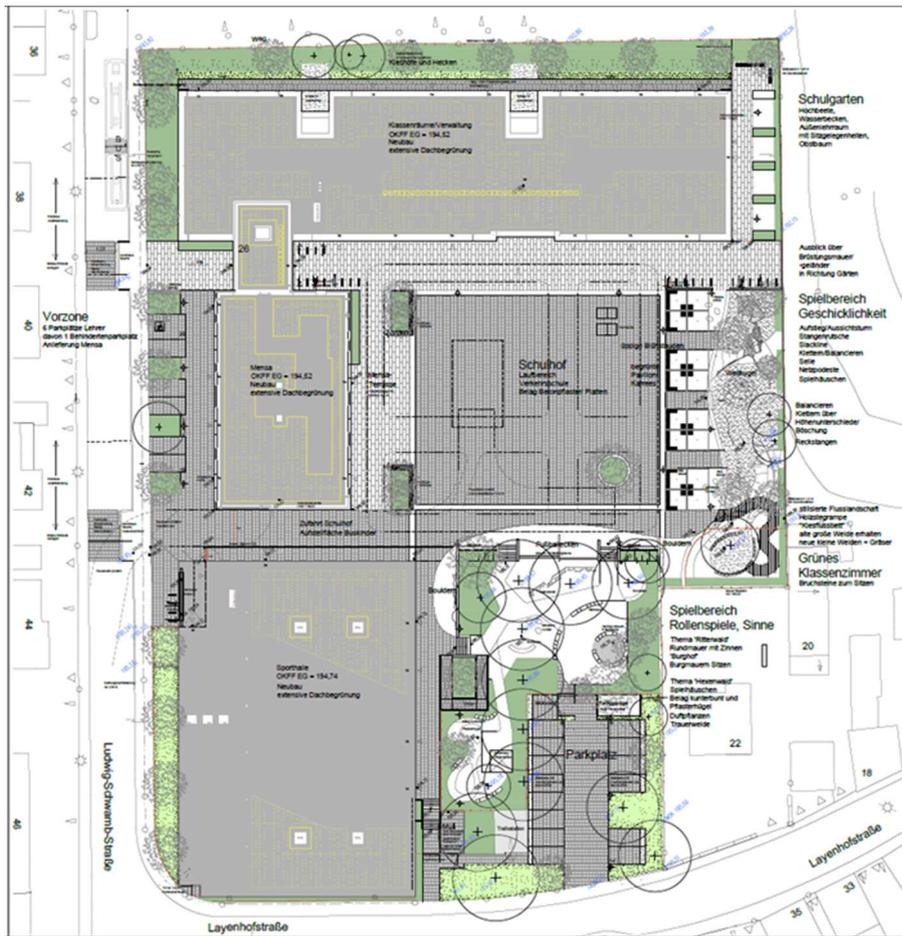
Darstellung der Bebauungsstruktur des Planszenarios städtebaulichen Struktur für das Plangebiet „Peter Härtling Grundschule“ (Quelle: Büro Heims)
